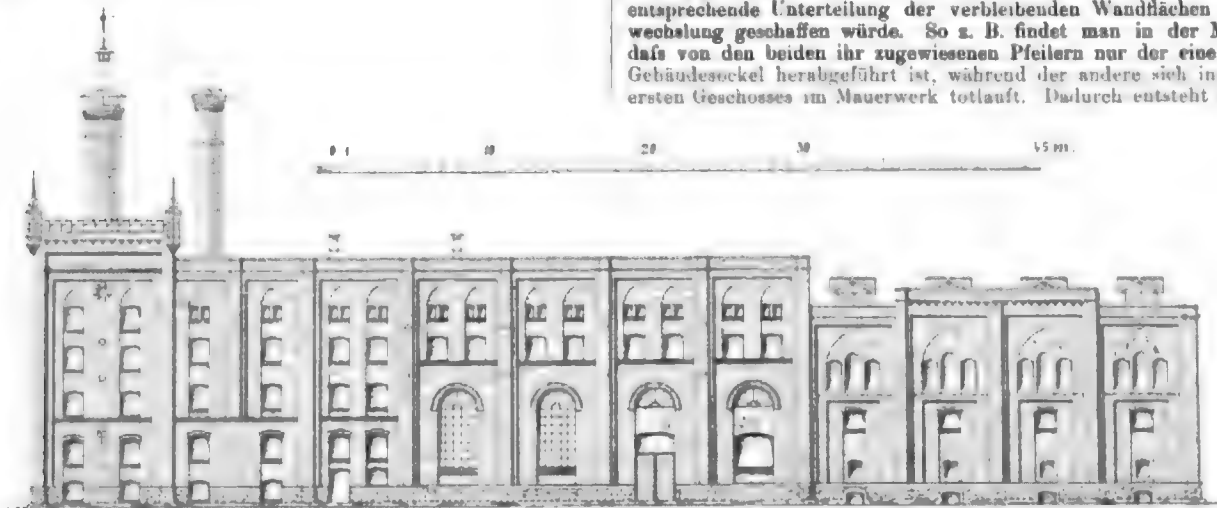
Fassade eines Brauerei- und Mälzereigebäudes.
